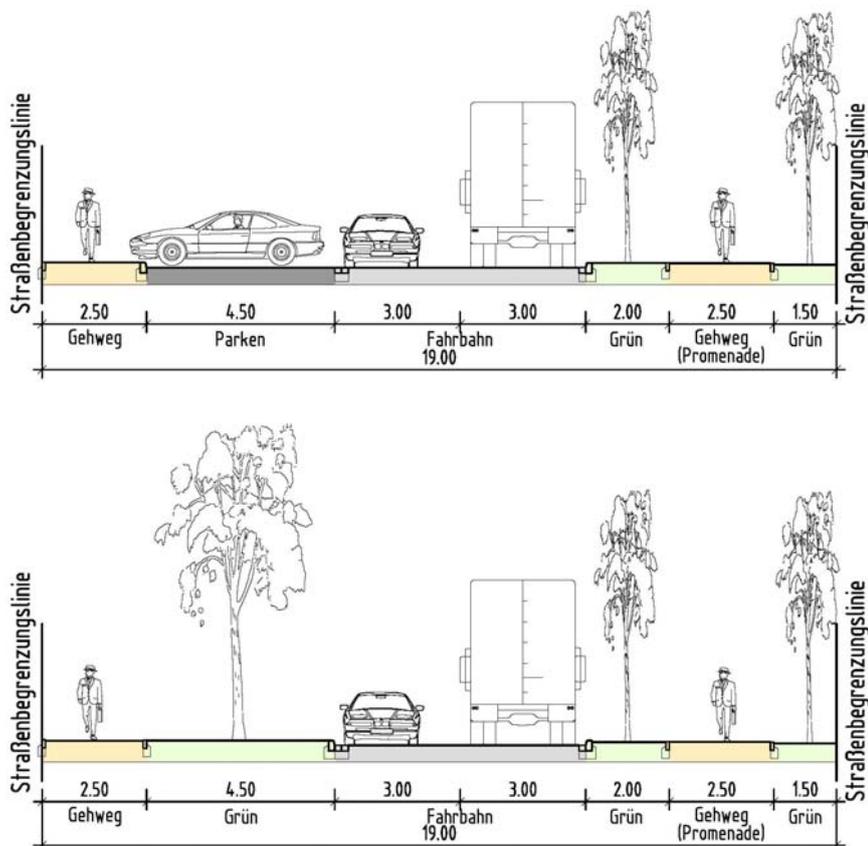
Querschnitt Haupterschließung / Planstraße A
